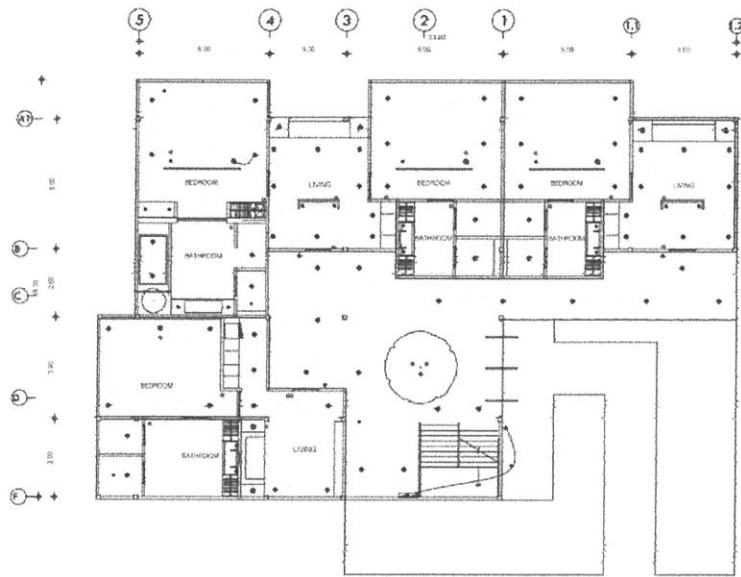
MAIN BUILDING ELECTRICAL PLAN
